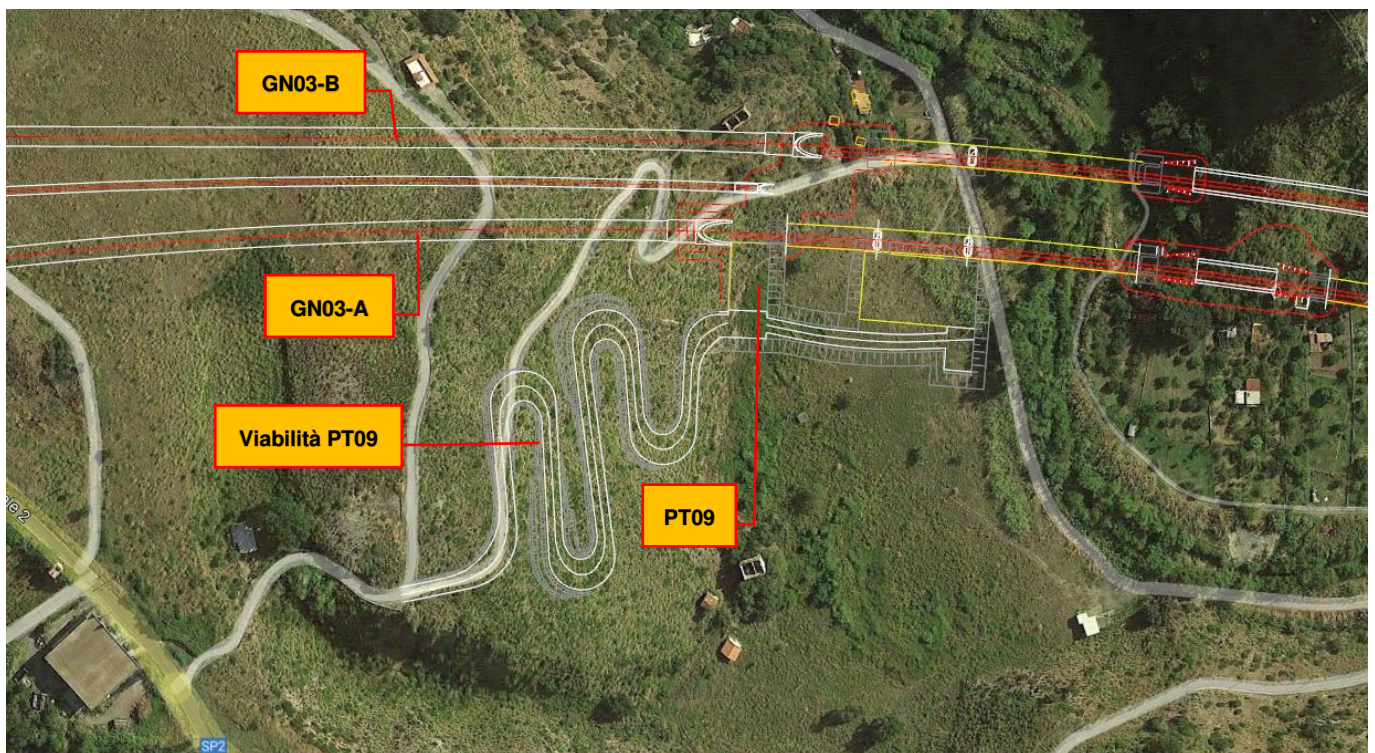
Planimetria con individuazione della nuova viabilità PT09
